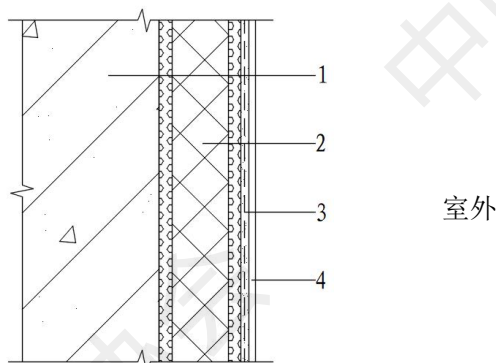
真空绝热预制混凝土复合保温墙板基本构造
